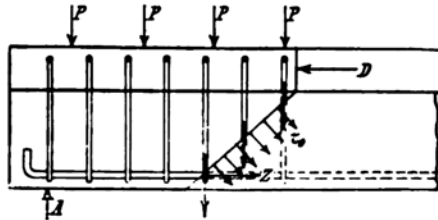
Fuerzas internas en trabe agrietada con estribos (Mörsch 1909)
